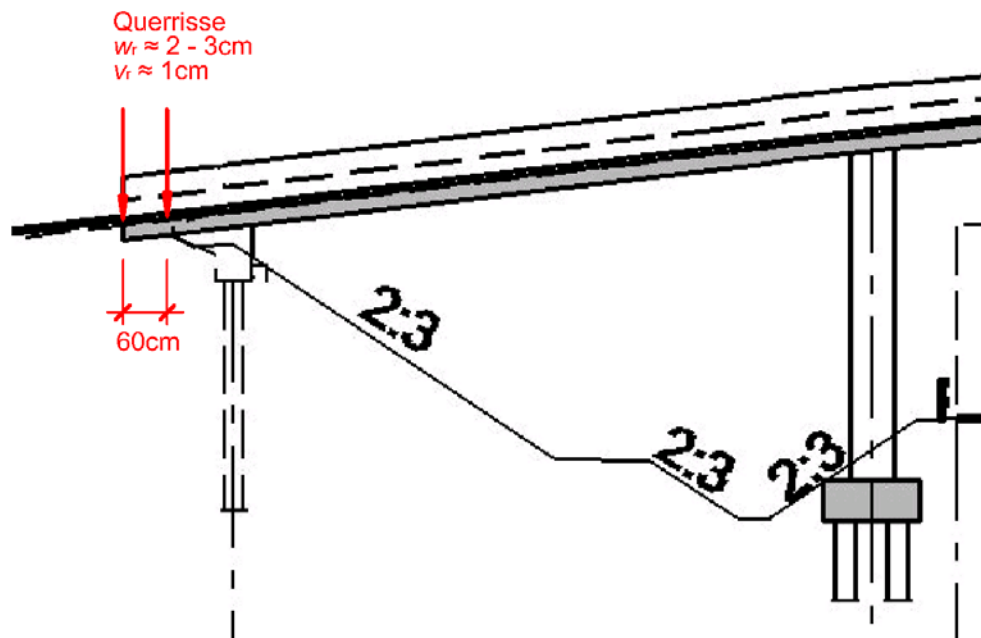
Belagsschäden linkes Brückenende BS 12 UEF Grienstrasse, Pieterlen
